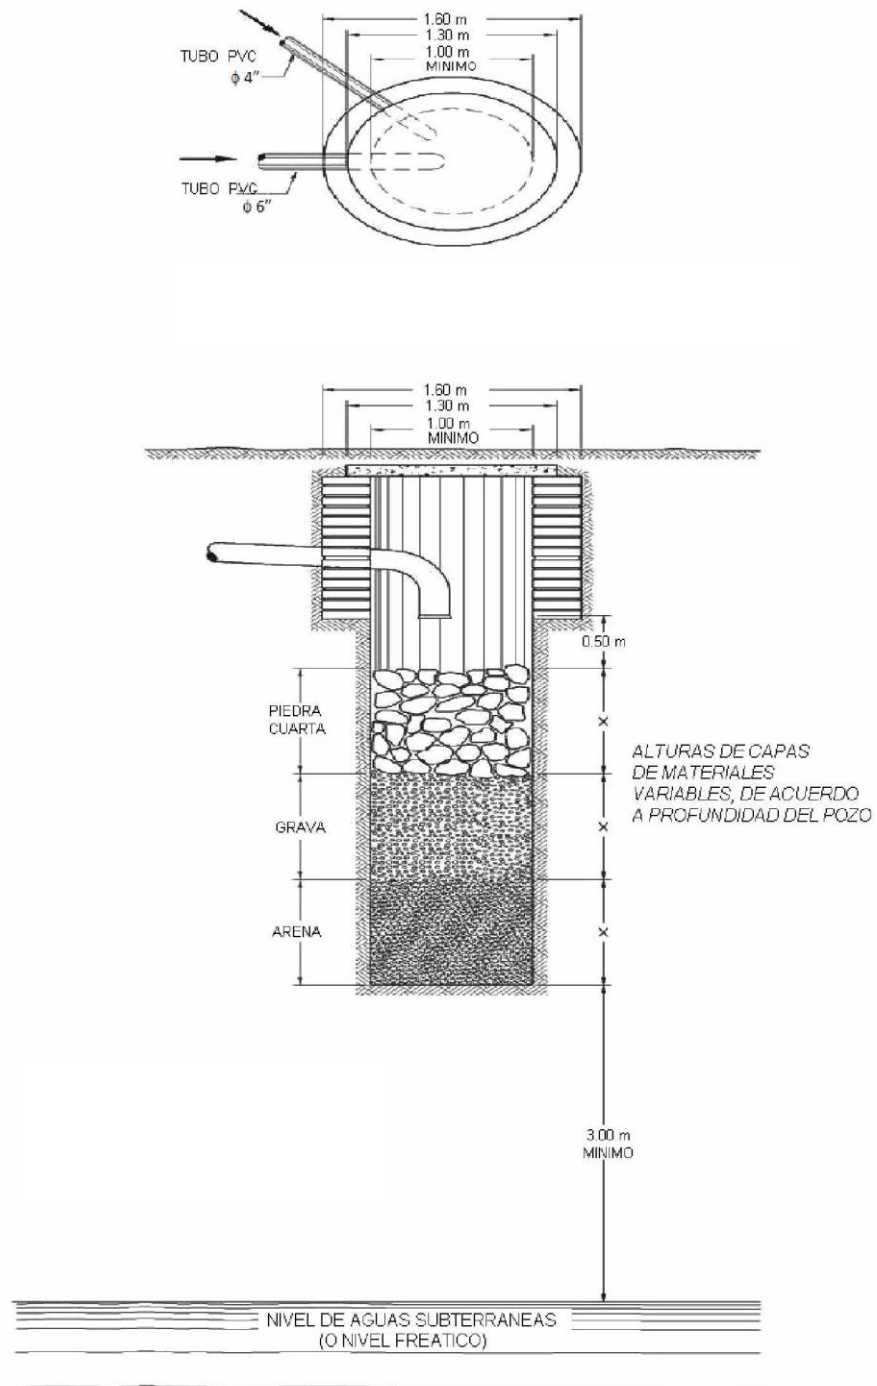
Esquema en planta y sección de un pozo de absorción
